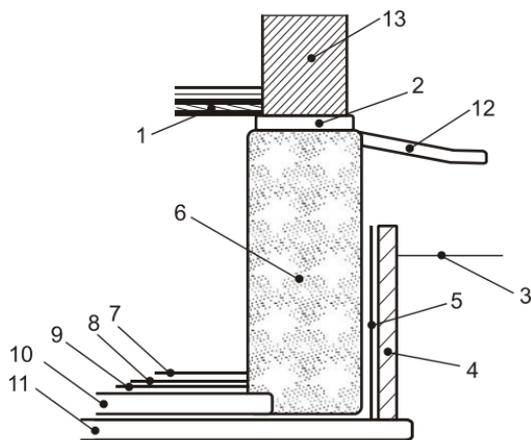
Устройство оклеечной гидроизоляции: 1 — перекрытие; 2 — горизонтальная гидроизоляция; 3 — уровень грунтовых вод; 4 — прижимная стенка (1/2 кирпича); 5 — вертикальная гидроизоляция; 6 — фундамент; 7 — чистый пол подвала; 8 — оклеечная гидроизоляция; 9 — цементная стяжка; 10 — железобетонная плита; 11 — монолитный бетон (подготовка); 12 — отмостка; 13 — стена
